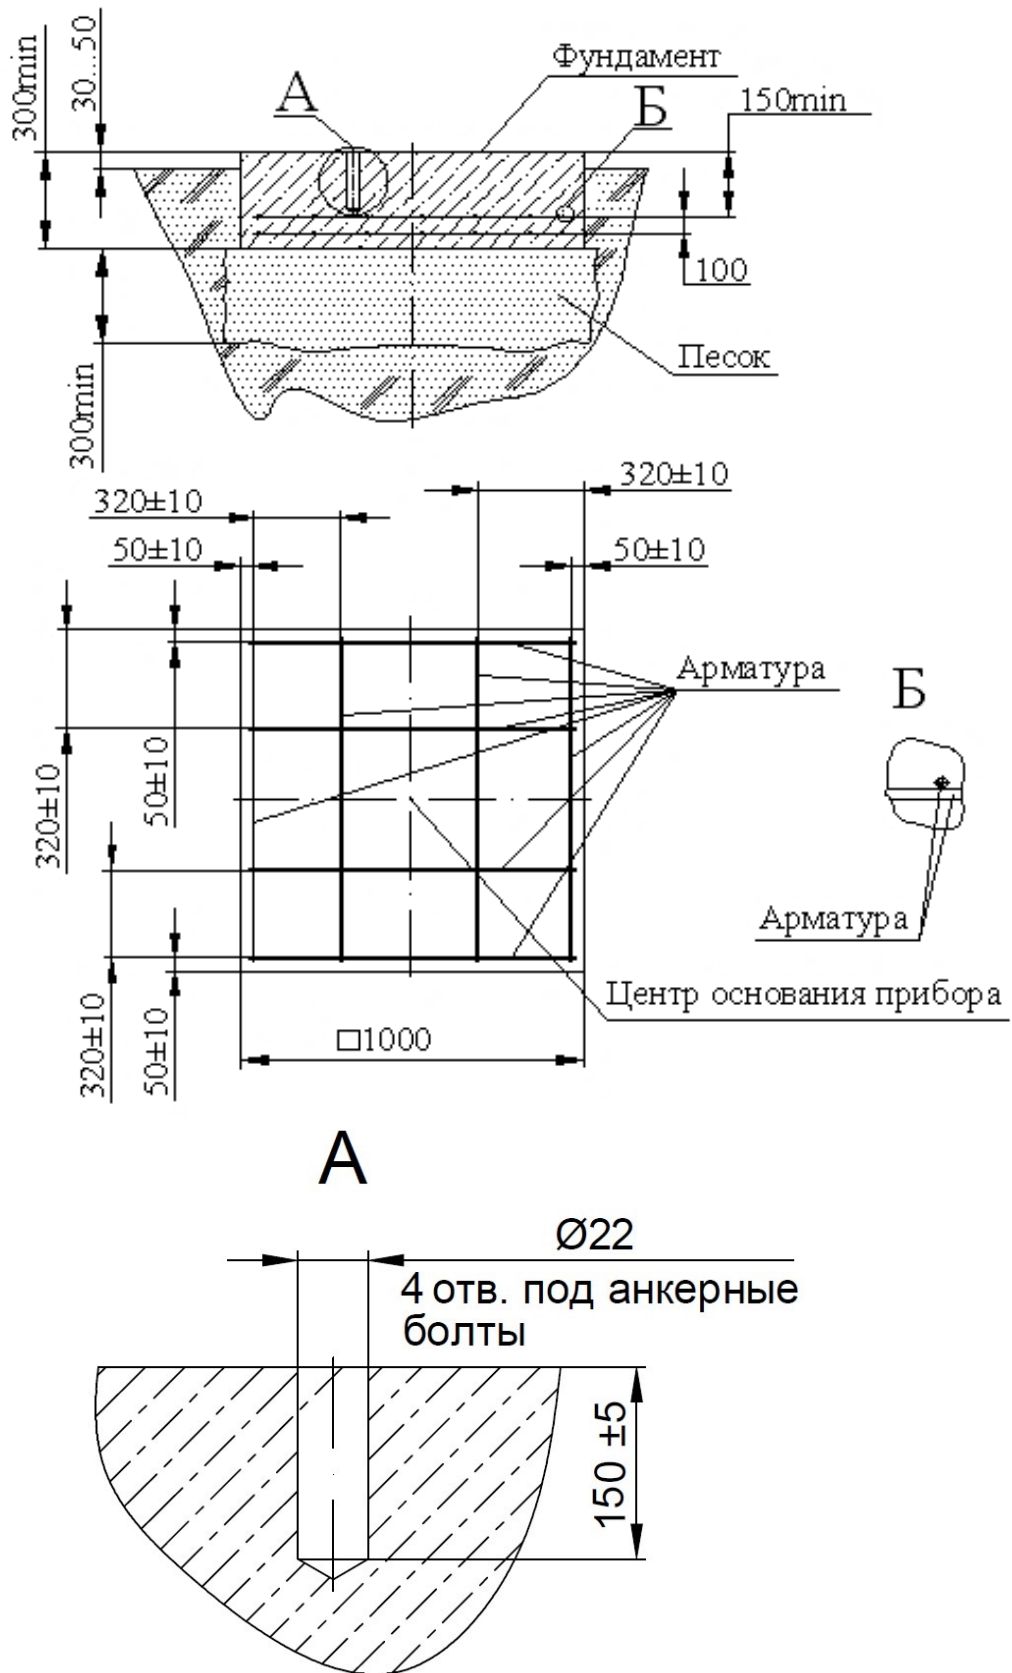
Рекомендуемый вид фундамента для установки прибора на устойчивых грунтах
